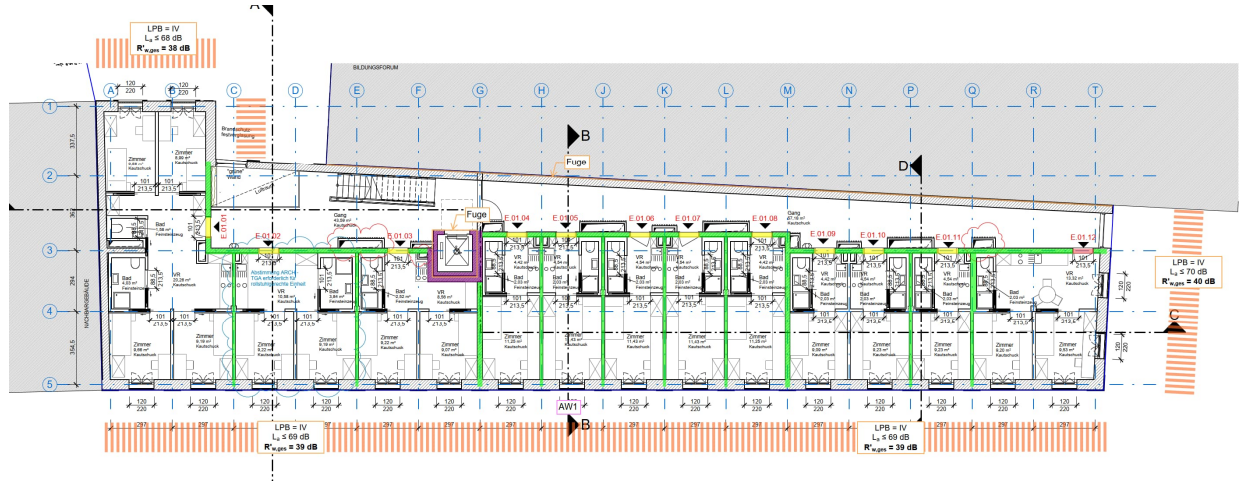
exemplarischer Grundriss 1. Obergeschoss mit dem maßgeblichen Außenlärmpegel
